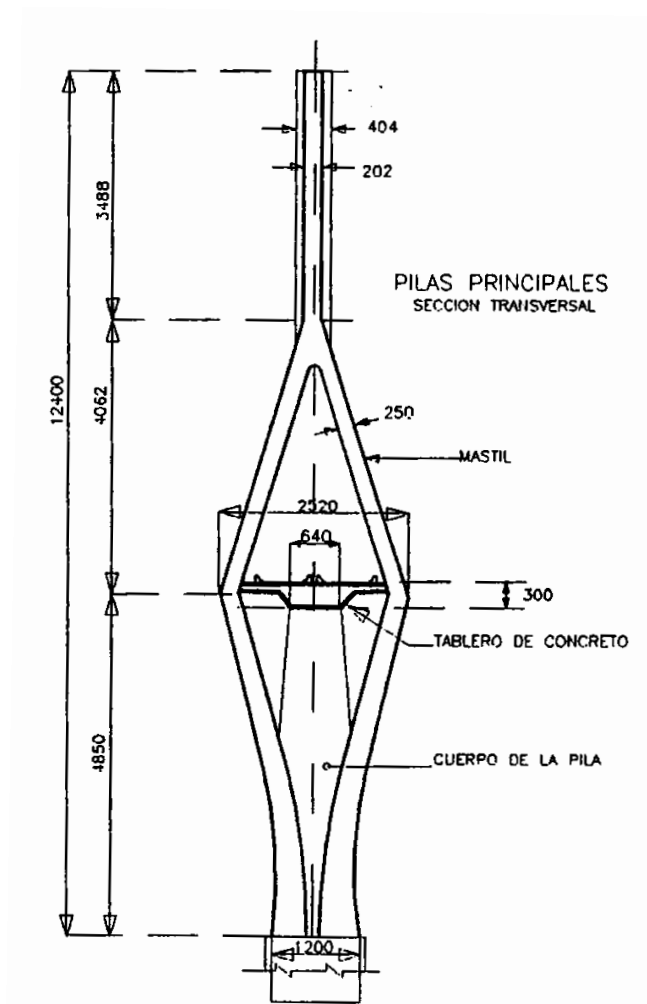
Vista de la sección transversal de las pilas transversales del puente Tampico (SCT, 1992).
